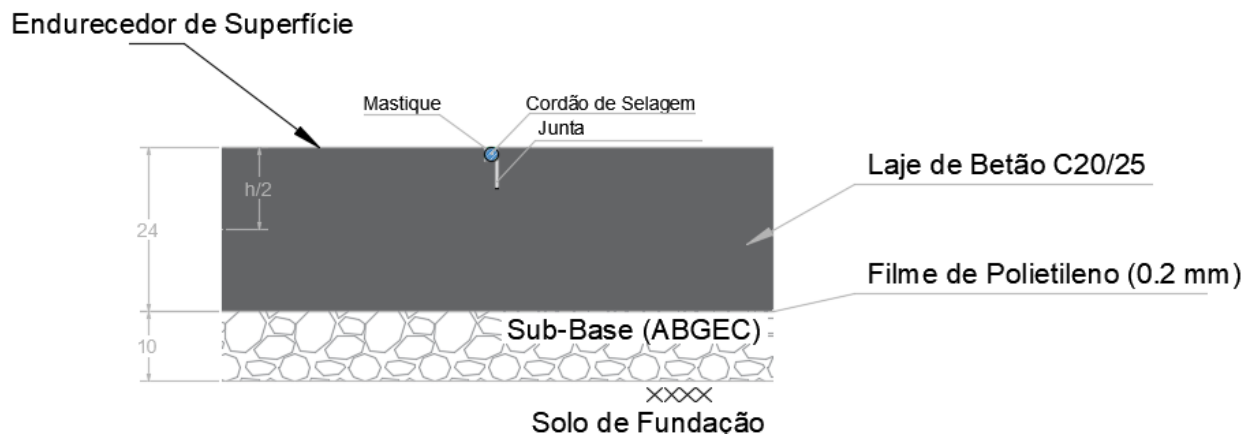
Exemplo de um pormenor de um pavimento rígido
